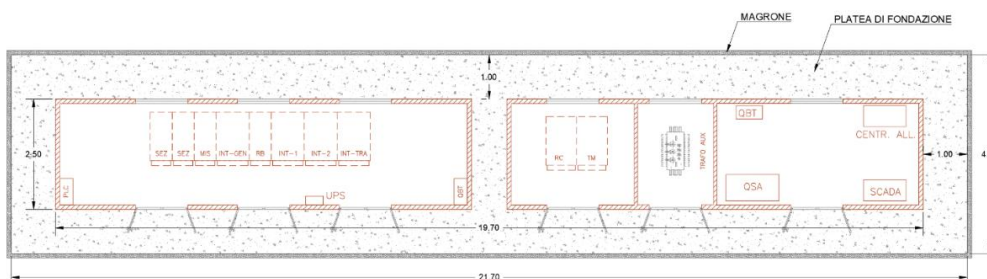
Pianta con platea di Fondazione della Cabina di Centrale
